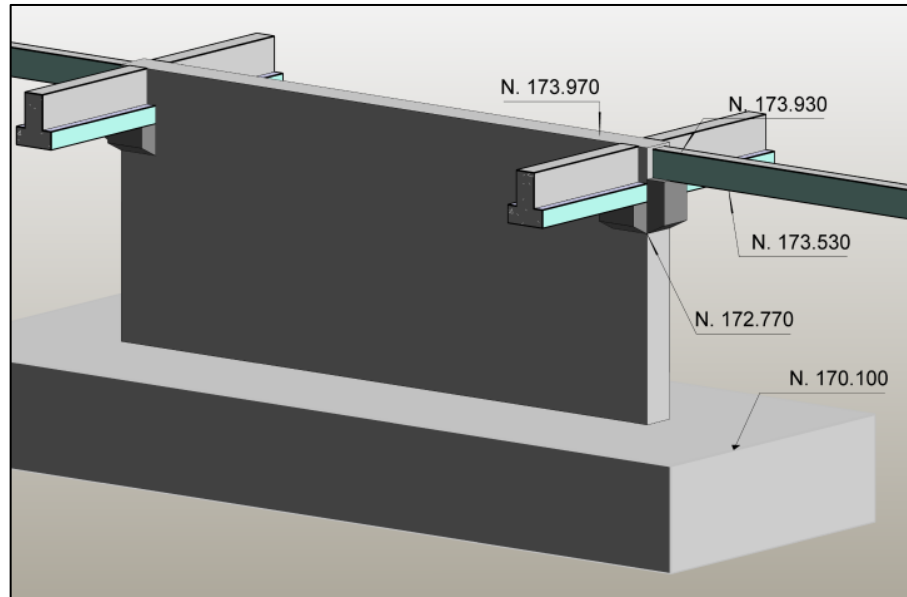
Detalle de Placa estructural del Estacionamiento con especificación de niveles para las ménsulas y vigas prefabricadas.
